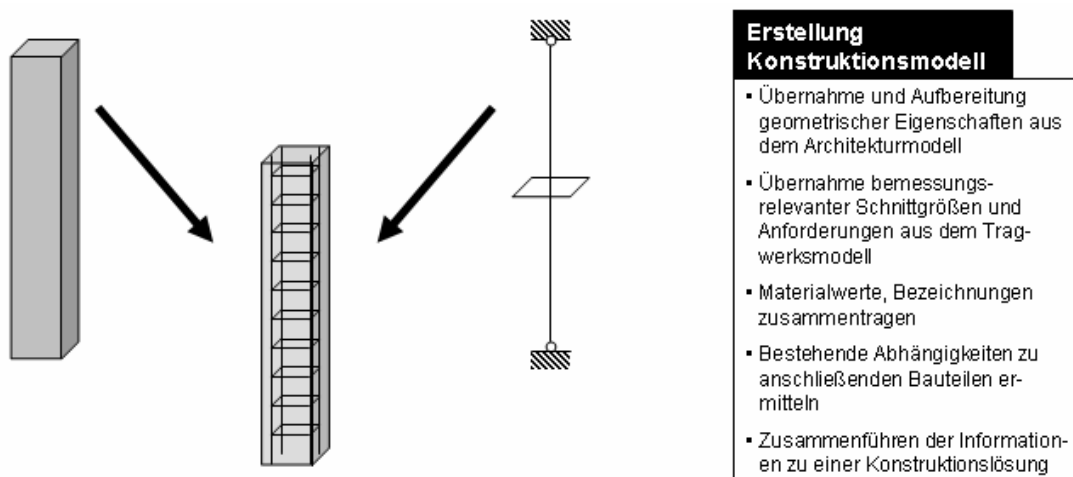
Vereinfachter Ablauf der Erstellung der Konstruktion einer Stahlbetonstütze aus den Fachmodellen „Architektur“ und „Tragwerk“
